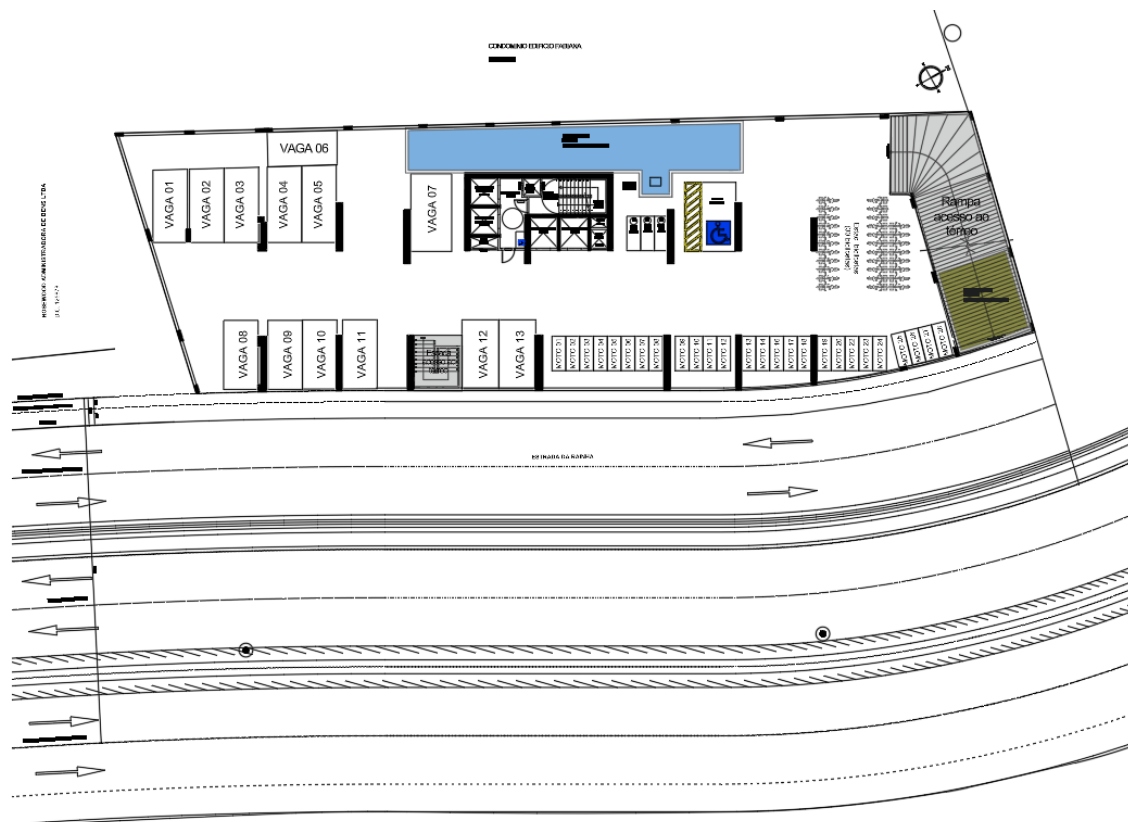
Planta do pavimento subsolo, utilizado para disposição das vagas de estacionamento para funcionários e visitantes/fornecedores.
